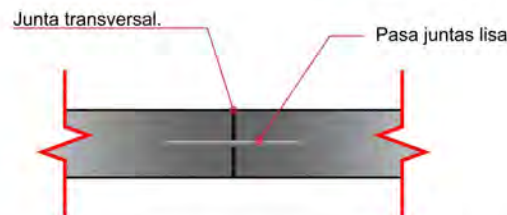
6 Colocación en junta transversal, pasa juntas lisa.
